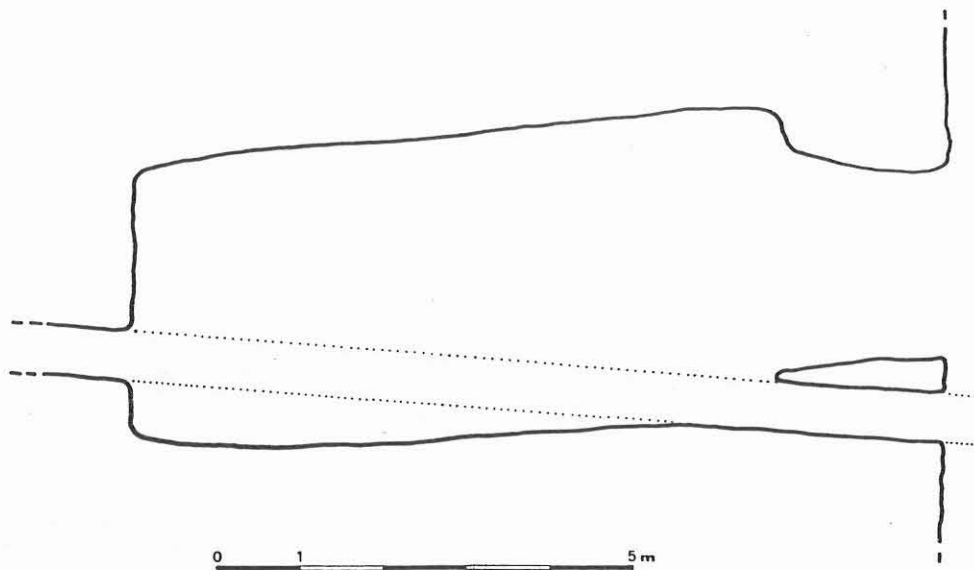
ambiente scavato nel tufo; pianta (n. 25)
